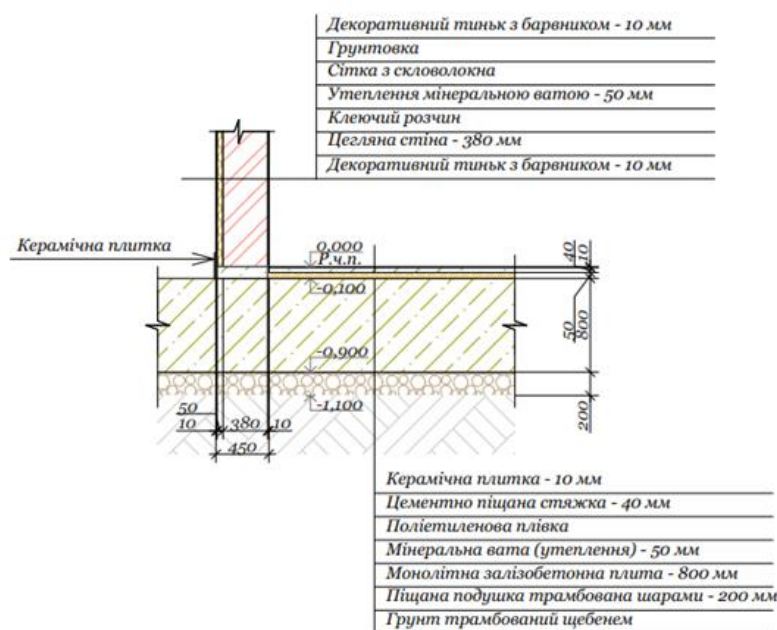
Схема плитного залізобетонного фундаменту. Схема зовнішньої несучої цегляної стіни.
